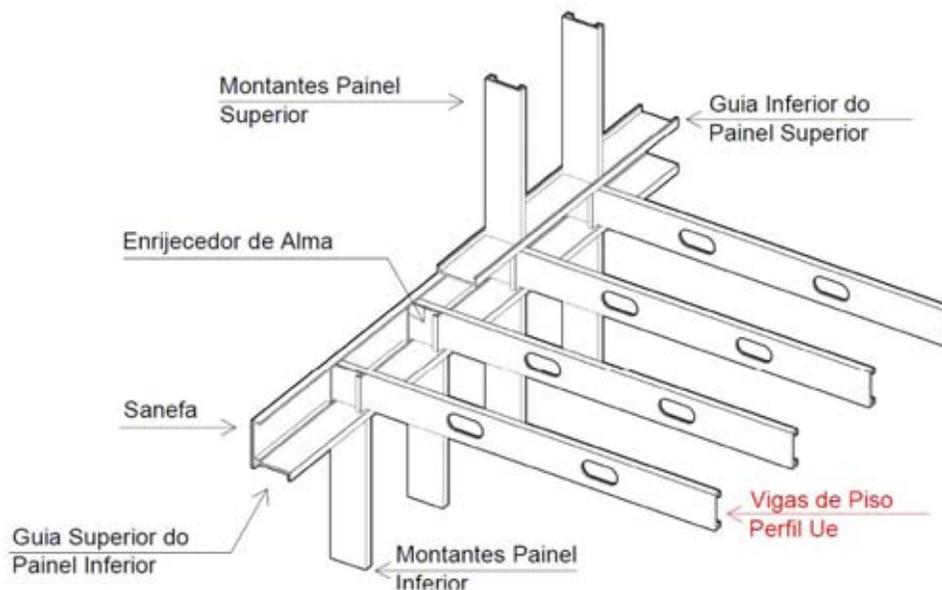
Detalhe das vigas de piso em laje para o sistema LSF
